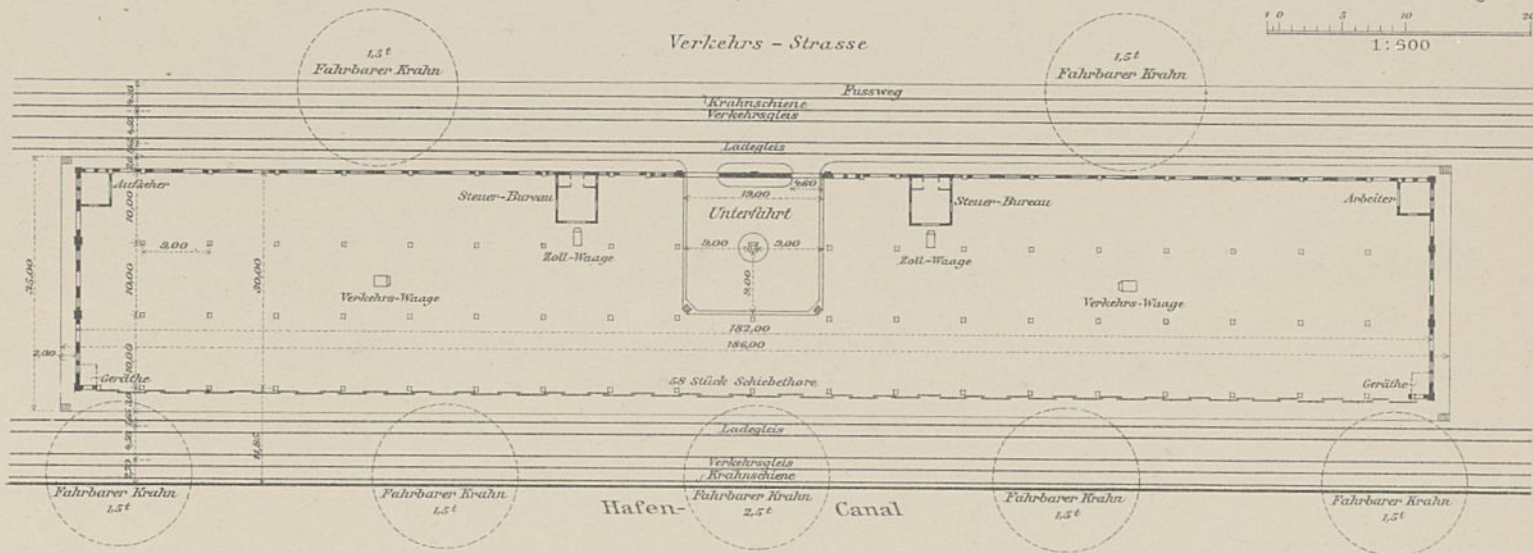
Grundriss des Kaischuppens. 1:1000.
